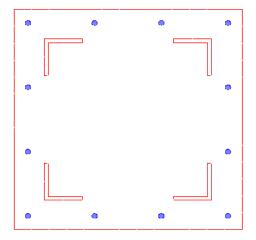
Сечение с жесткой арматурой, образованной из уголков
